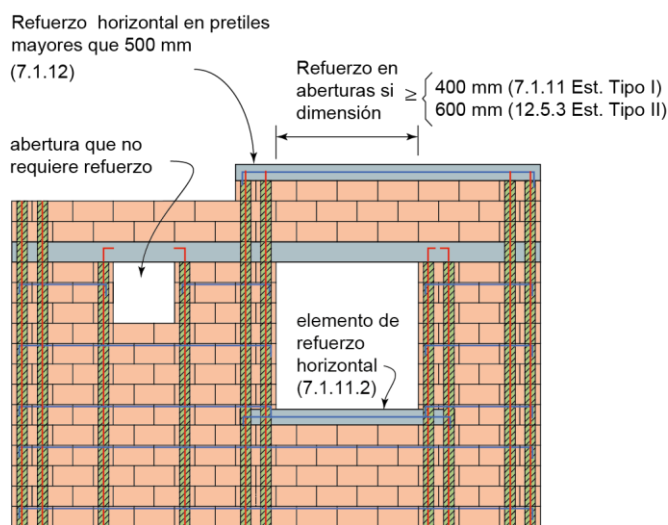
Refuerzo en aberturas y pretil
